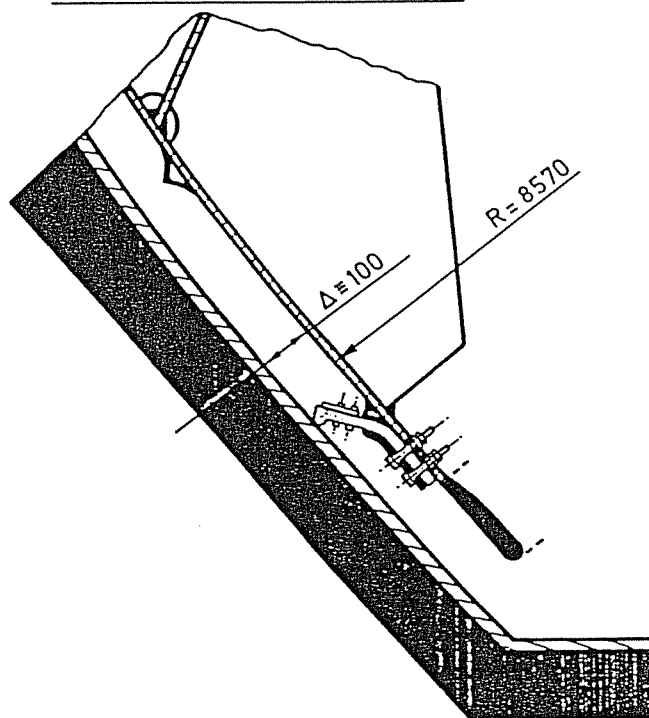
Etanchéité au pied de la vanne, celle-ci ne reposant jamais sur le radier
